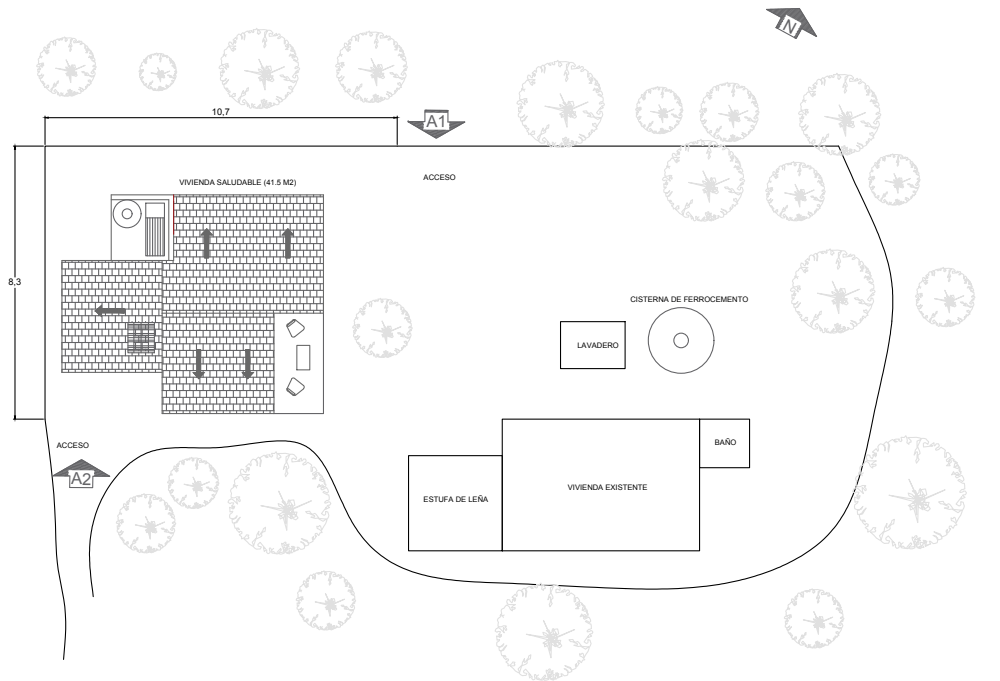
Planta de conjunto sin escala (fuente: Elaboración propia)
